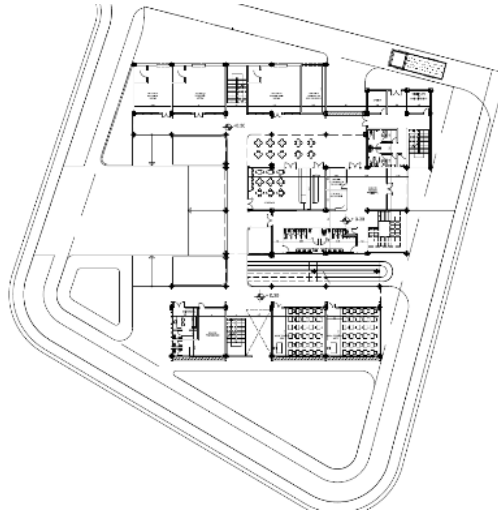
Imagen de Planta baja de Centro de Capacitación Laboral. Villamizar y otros (2017)
